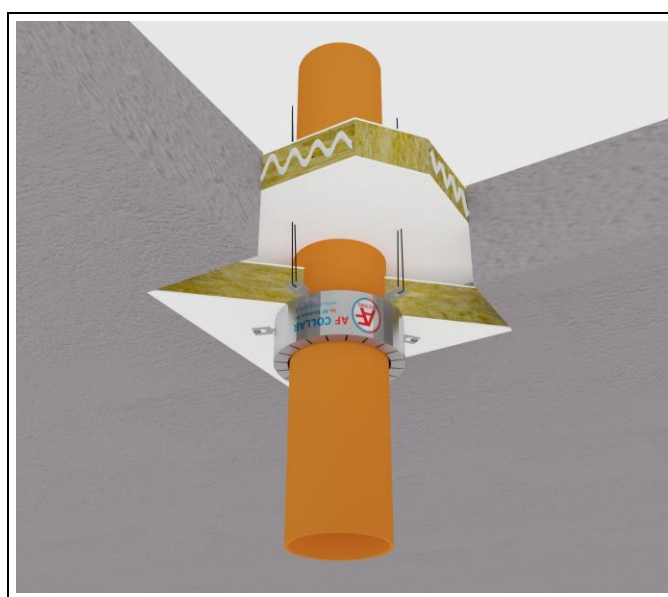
Esempio di un KF-Collar fissato con cavi d'acciaio ad un solaio.
